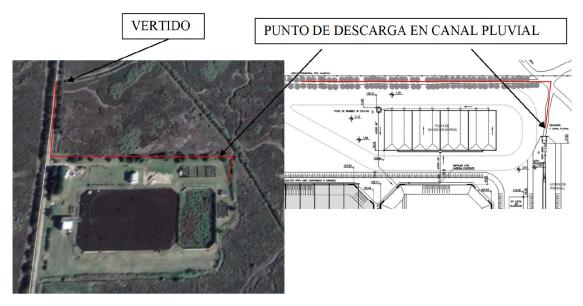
Vista en Planta de la Planta Depuradora desde Google Earth (recuperado el 5/10/2020). Señalización del Punto de vertido.
